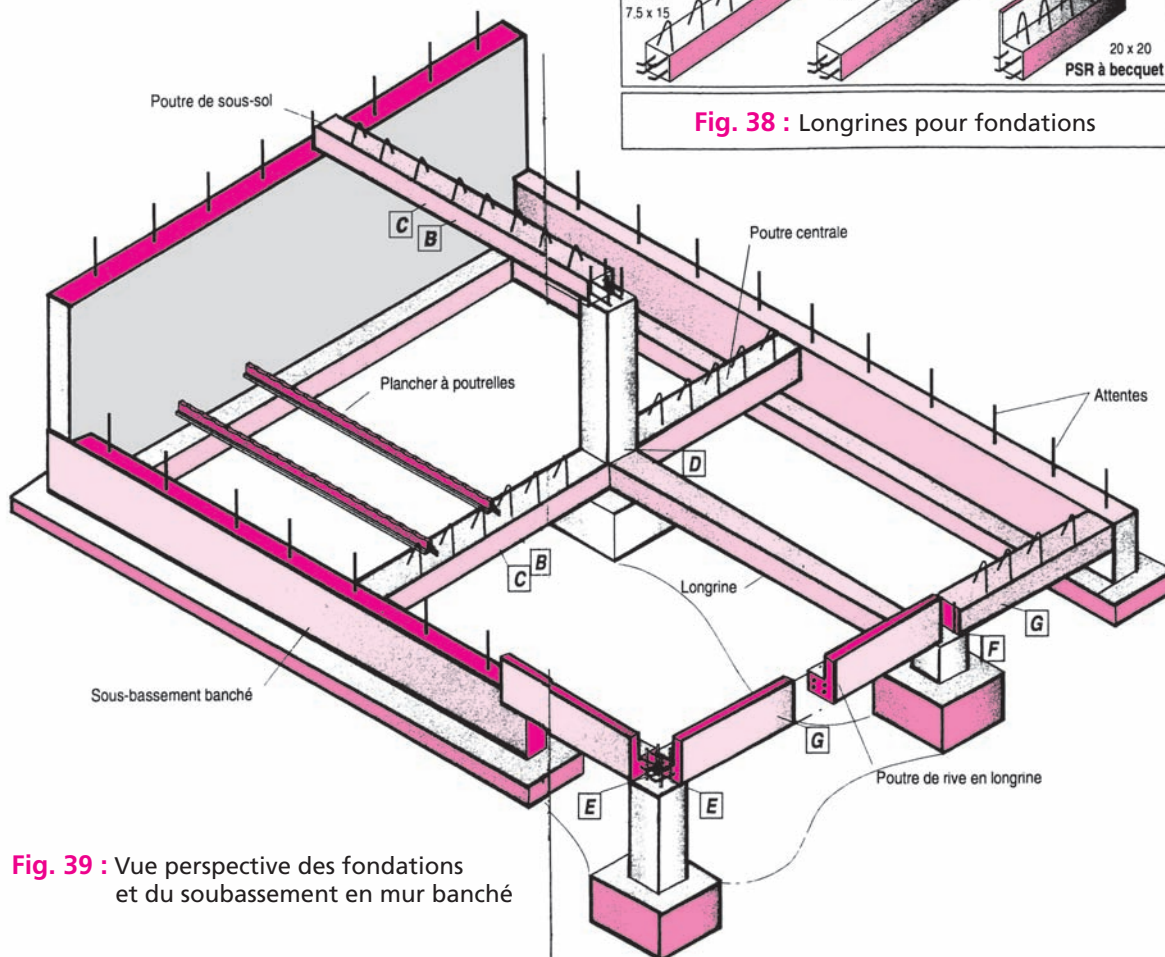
Vue perspective des fondations et du soubassement en mur banché
